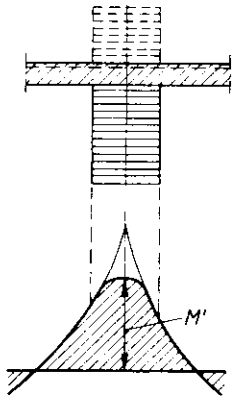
Momentenausrundung bei nicht biegesteifem Anschluß an die Unterstüttung, z. B. bei Auflagerung auf Wänden
